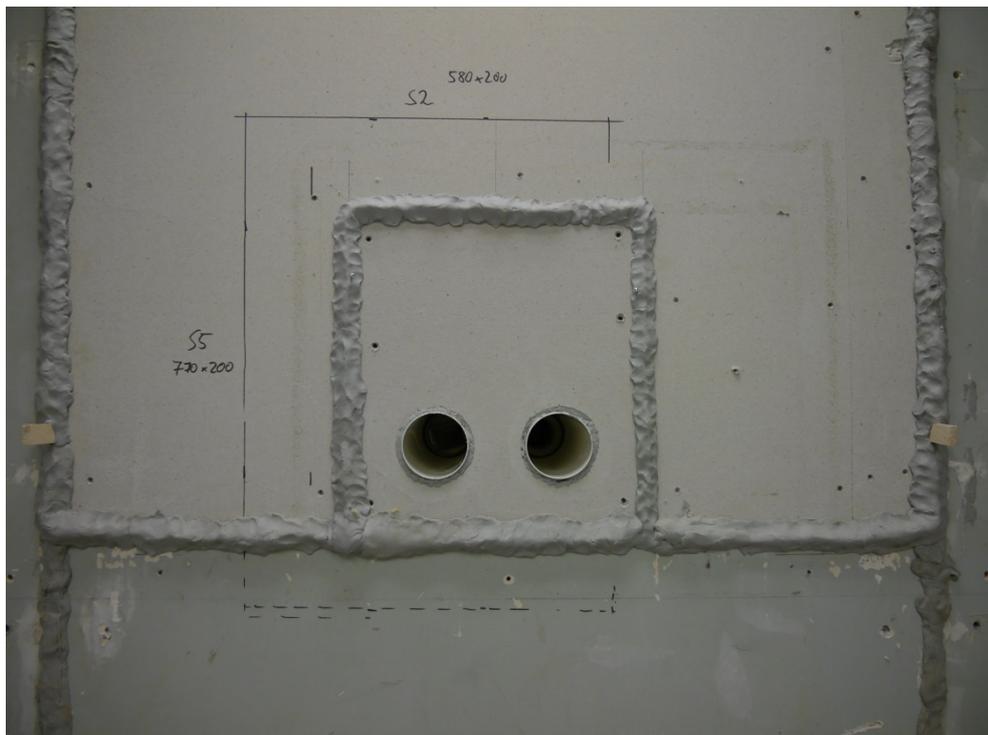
Lüftungsöffnungen außenseitig (Fortluft links, Außenluft rechts), Fassadenabschluss Edelstahlschote noch nicht montiert.
